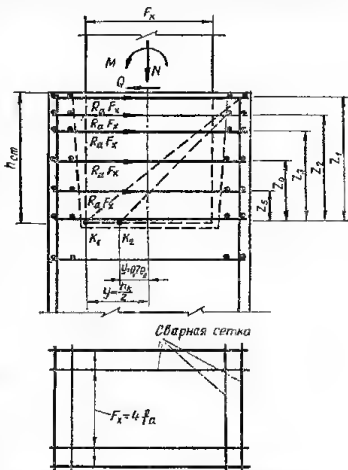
К расчету поперечной арматуры стенок стакана.
